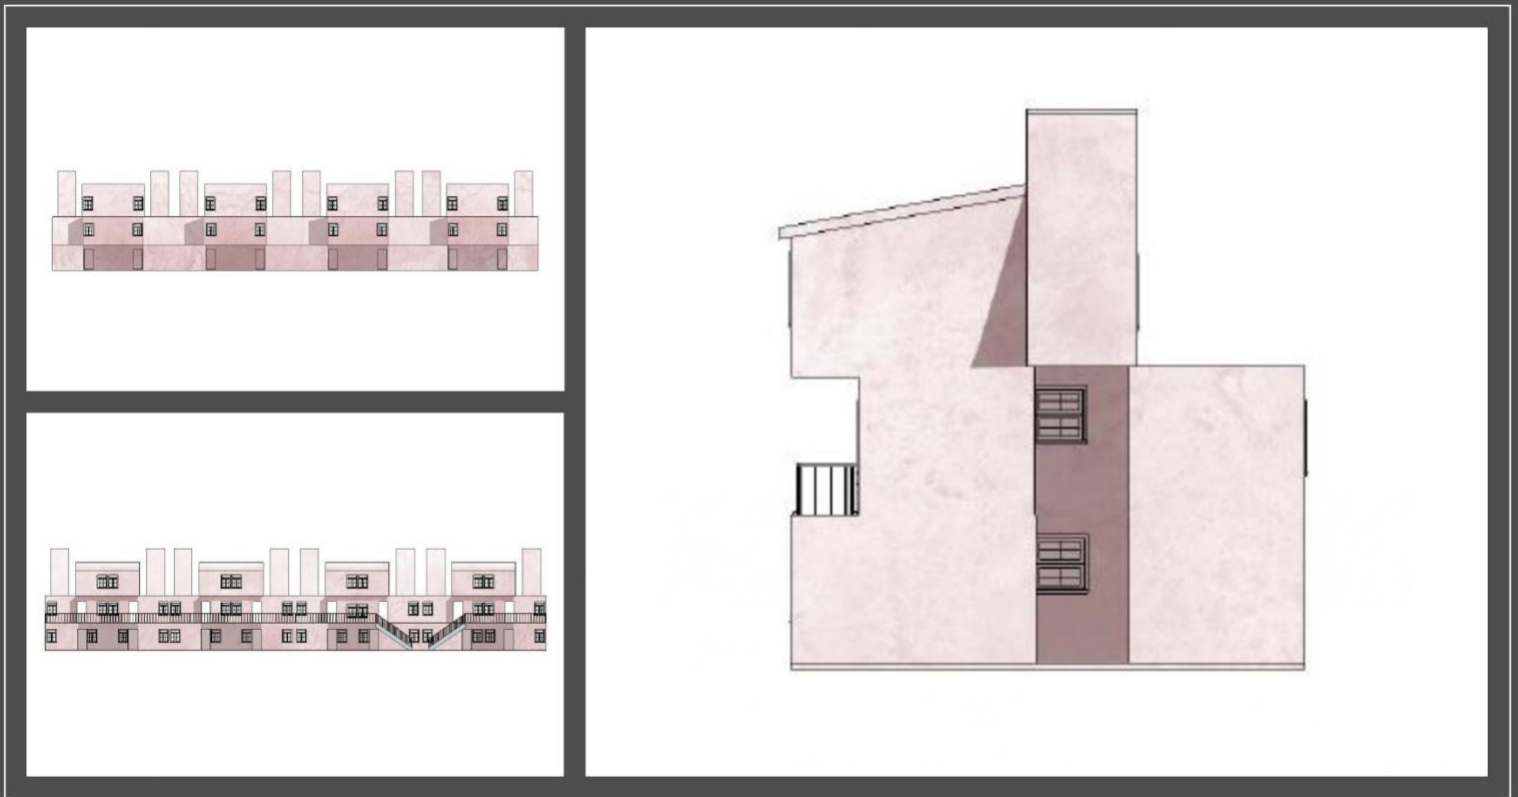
Fachadas posterior, frontal y lateral – Proyecto Palo Alto
